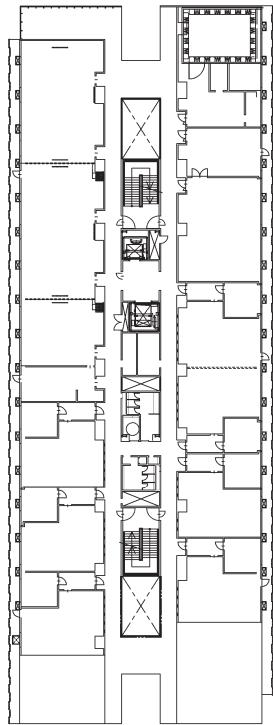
(1) 研究棟平面図（地下1階～地上3階）(1/2)
